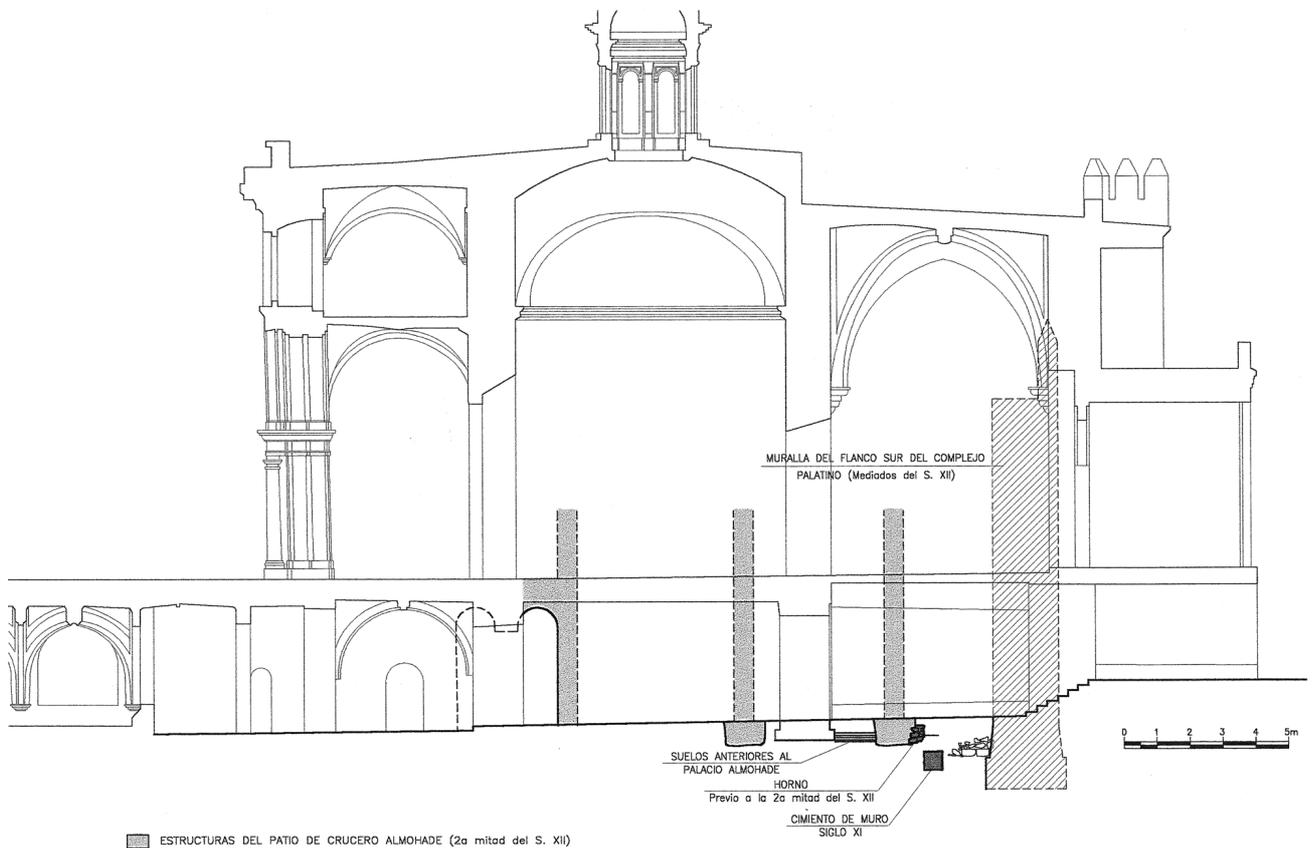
Sección Norte Sur de la Galería de los Baños con los nuevos restos localizados en el subsuelo.
